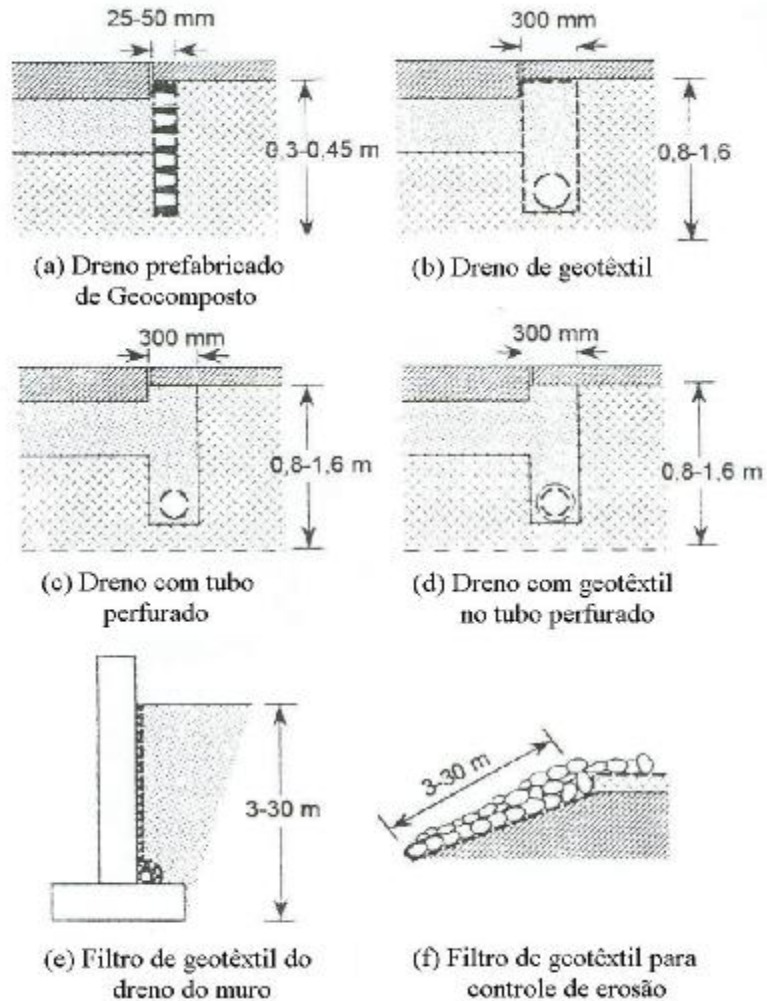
Sistemas de drenagem exumados (modificado – Koerner et al., 1996).
